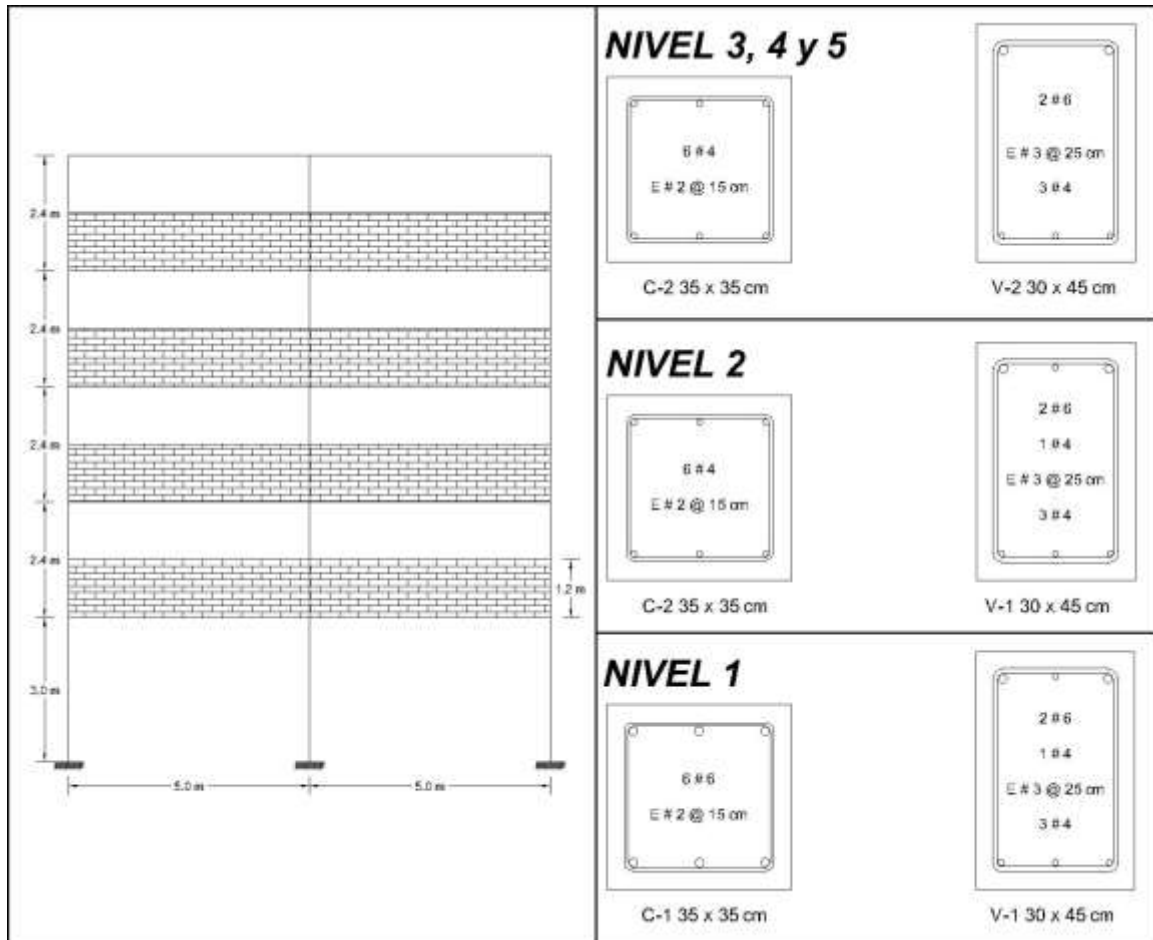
Armado de vigas y columnas para MCR de 5 con ML diseñadas con el RCDF-1977 (DDF, 1977a)
